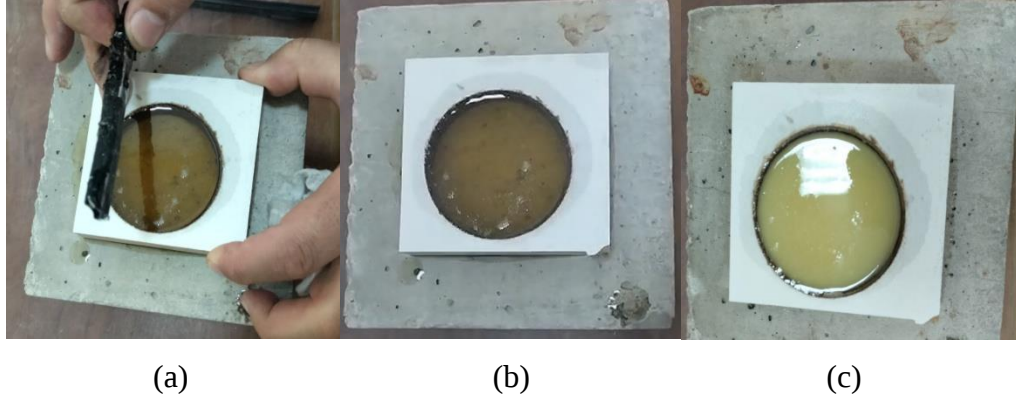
Beton yüzeyine termoset beton için kalıp konulması
